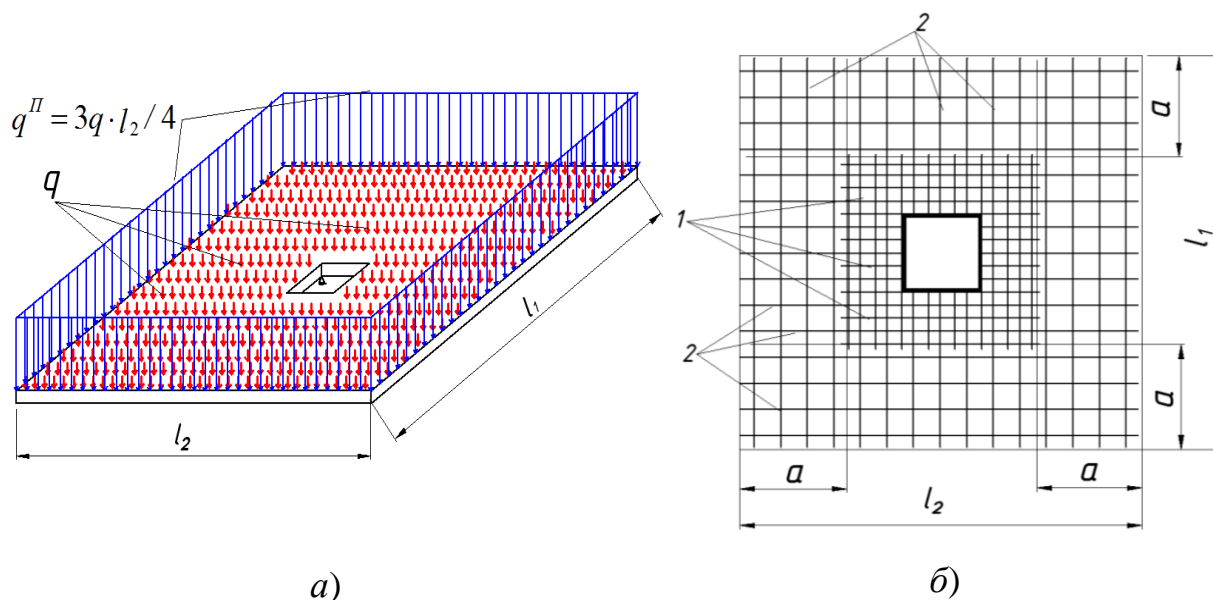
Схеми завантаження (а) та армування (б) надколонної плити:
